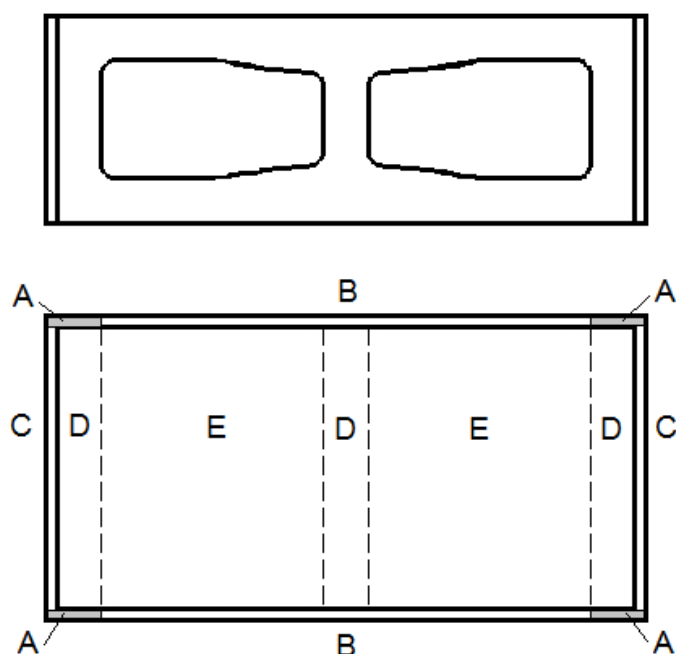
Bloco de concreto atual do mercado dividido em seções.
